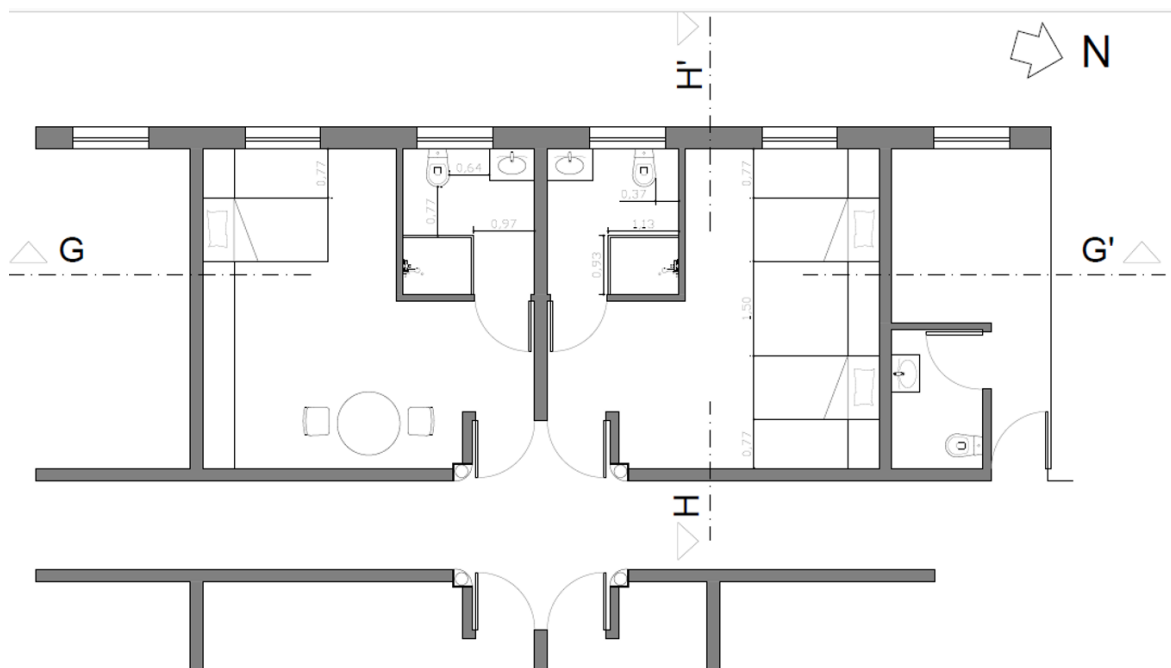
Planta dos quartos (individual e duplo) - piso inferior
